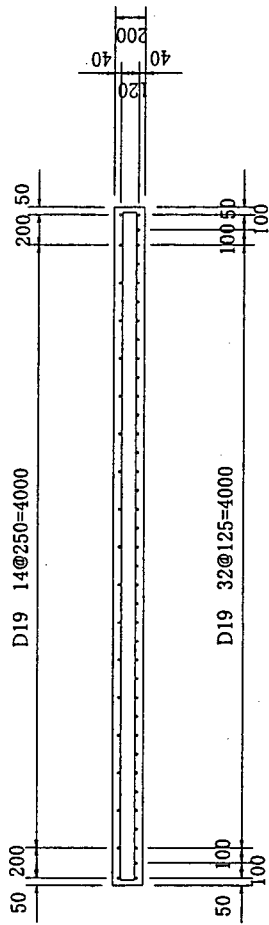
RC47供試体の形状・寸法 (単位:mm)
